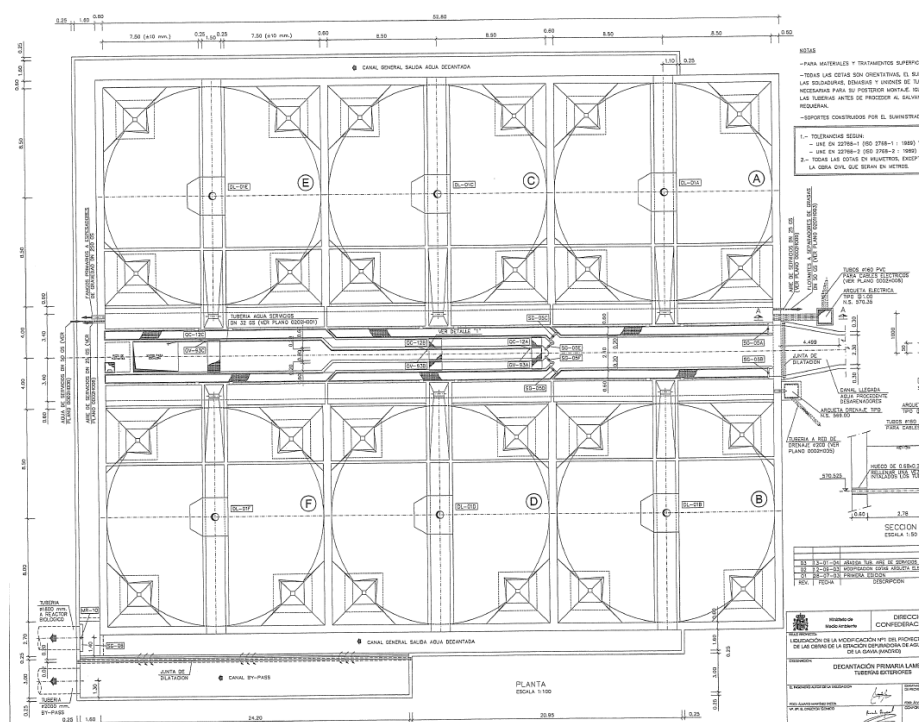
Plano en planta de la decantación primaria en la EDAR La Gavia.
